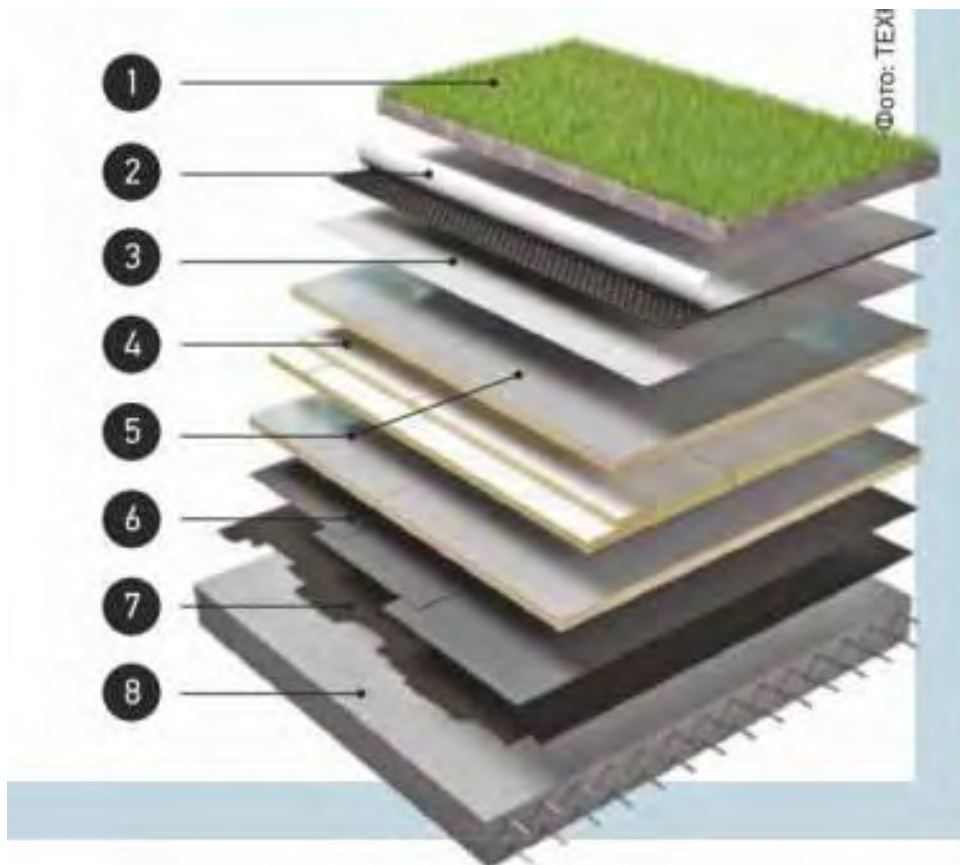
Система експлуатованої кровлі з захисним покриттям з ґрунтом із зеленими насадженнями. 1) ґрунт з зеленими насадженнями; 2) профільована мембрана; 3) полімерна мембрана; 4) плити теплоізоляційні; 5) плити теплоізоляційні; 6) рулони з гідроізоляцією; 7) праймер бітумний; 8) залізобетонна пошта підстави.
